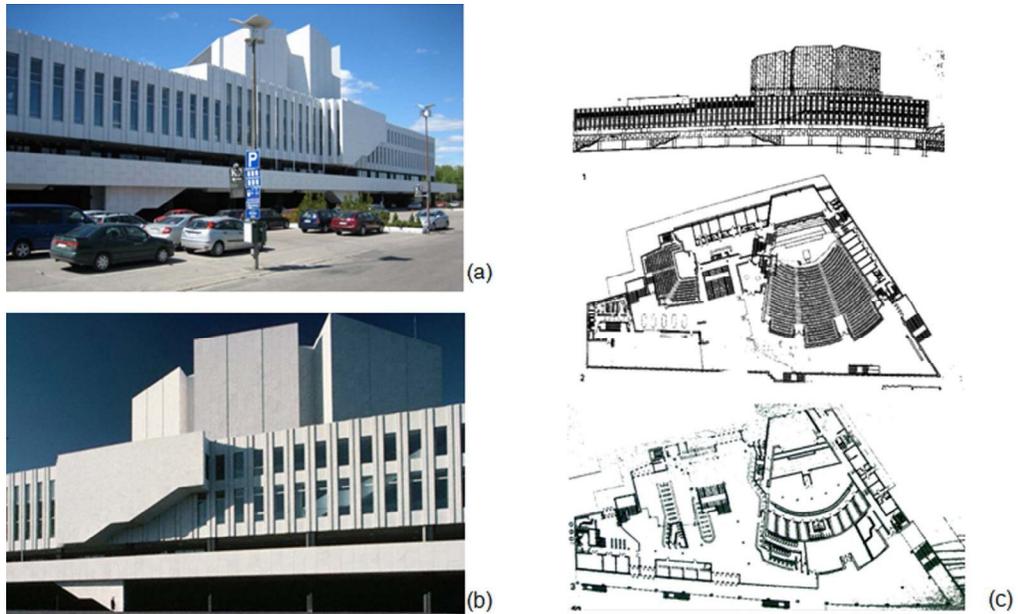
Alvar Aalto, Palacio de congresos con sala de conciertos, Helsinki, Finlandia, (1967-1971): (a) Vista exterior principal general, (b) Vista exterior, (c) Alzado, Planta arquitectónica de las salas, Planta baja.
